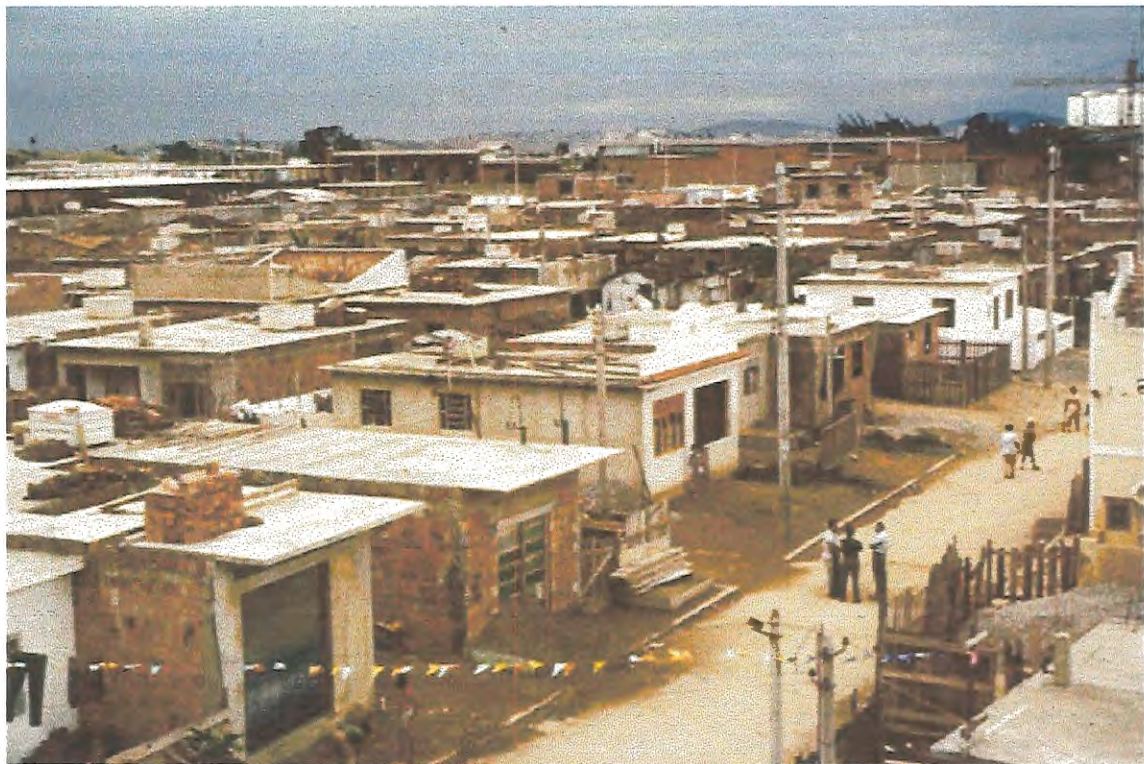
VISTA GERAL DEPOIS DA OBRA
